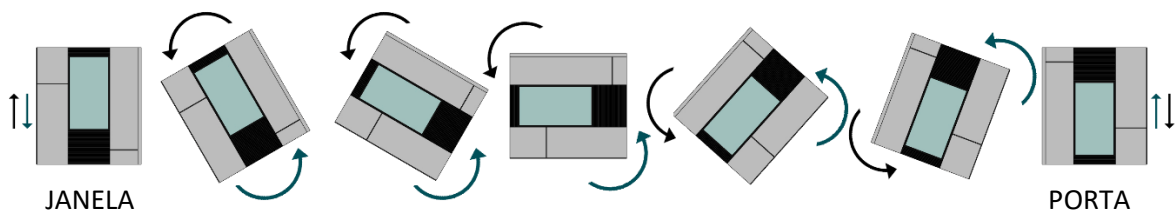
Esquema De Fachada Adaptativa – Fonte: Autoral
